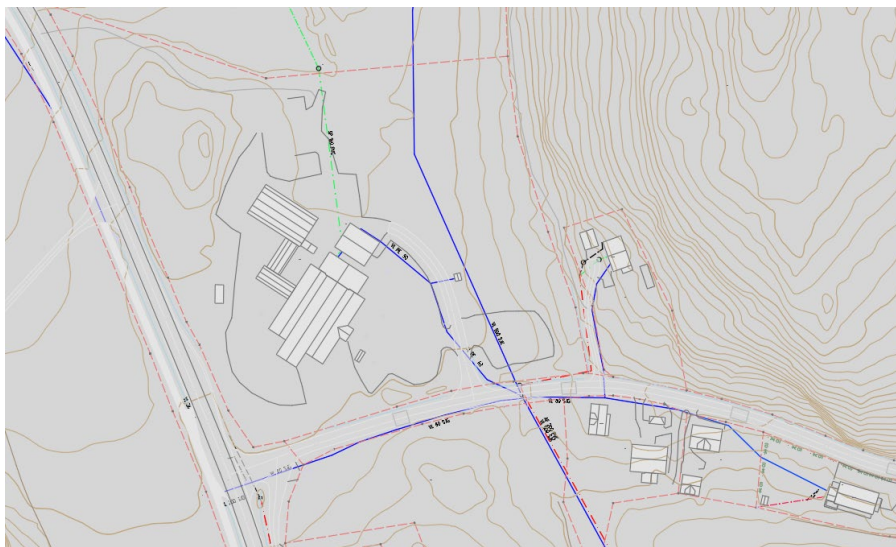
Forslag til situasjonsplan. Kilde Astrup&Hellern
